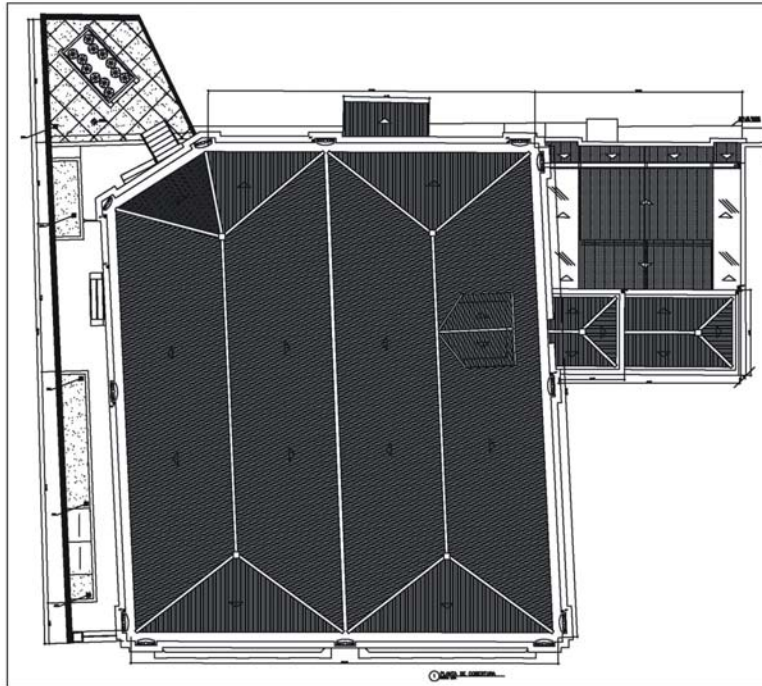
Planta de cobertura – prédio Anexo e passarela – sem escala.
